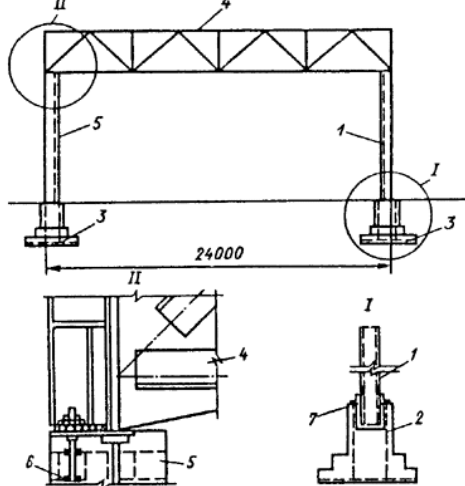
Молниезащита здания II категории с металлическими фермами (в качестве токоотводов и заземлителей использована арматура железобетонных колонн и фундаментов):
